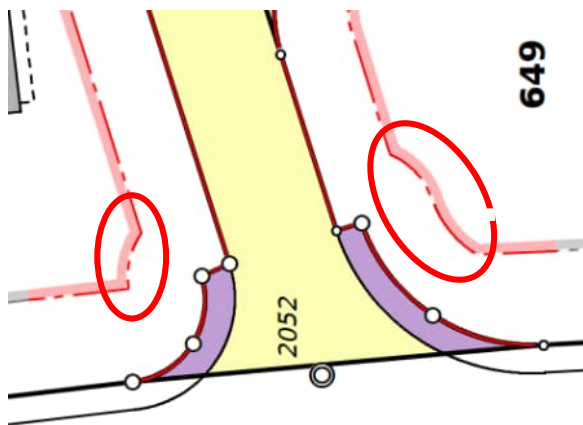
Einlenker mit Rücksprung Trottoir, Baulinie durch Parallel-kopieren der Strassenlinie erstellt → nicht erwünscht (Quelle: Geoportal)
